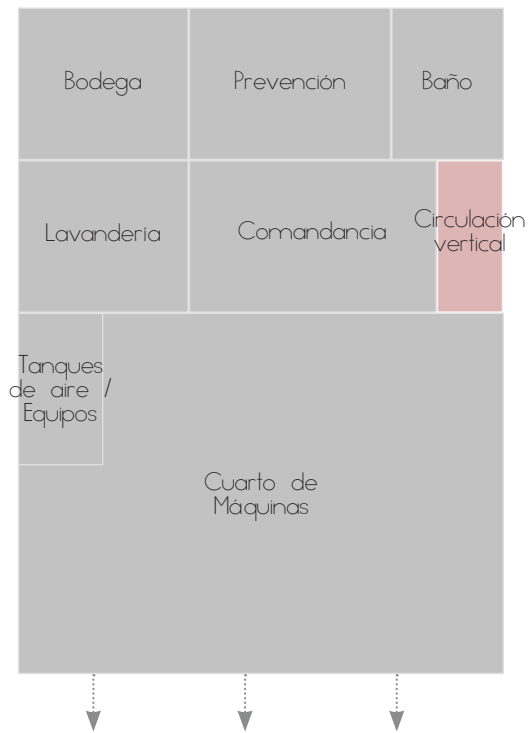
Zonificación planta baja estación N°2. (Autoras, 2019)
